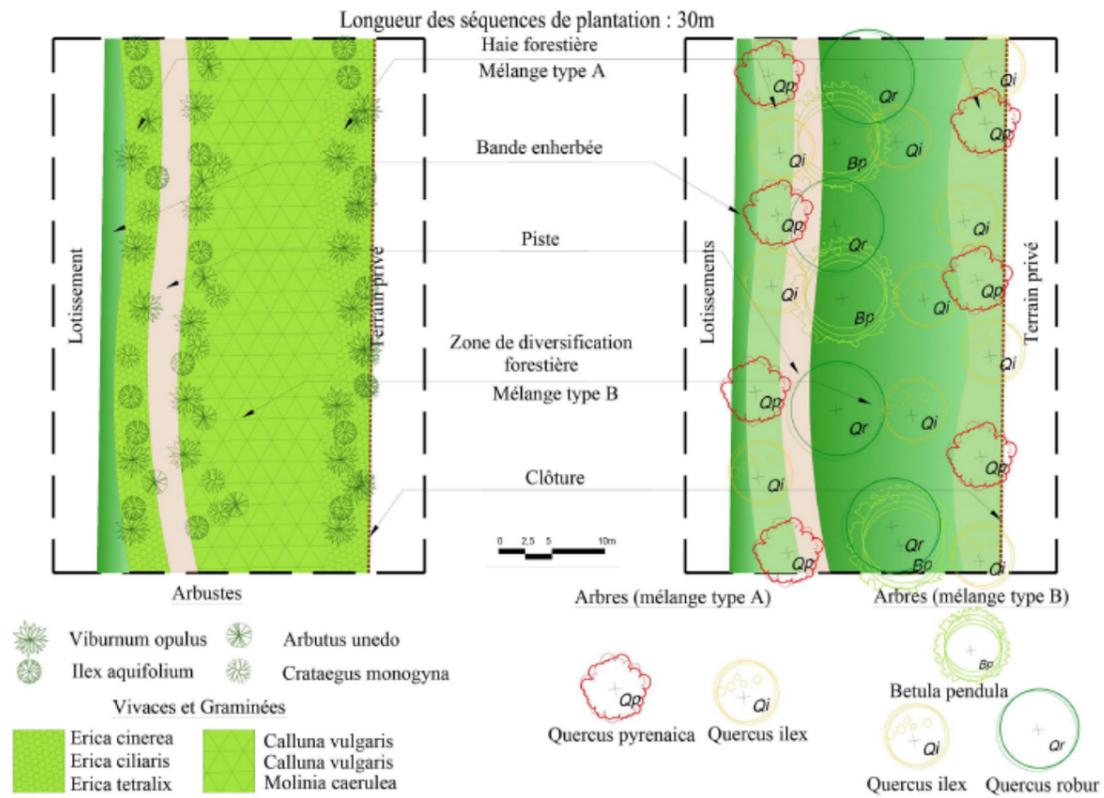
Plantations sur l'interface paysagère avec le lotissement d'habitations
